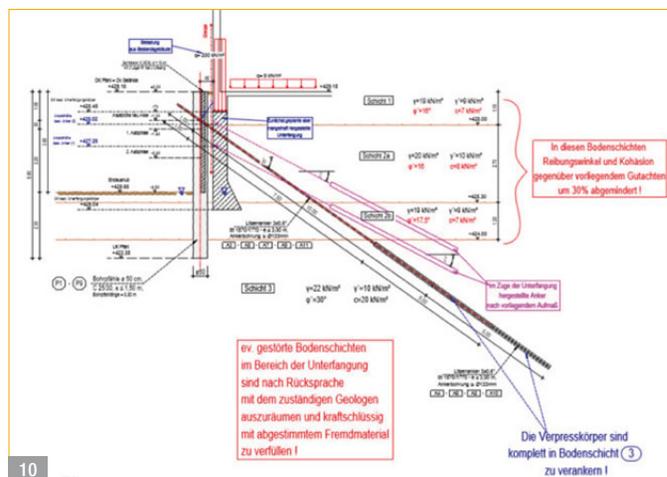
Detailschnitt der geänderten Baugrubensicherung (mit Darstellung der ursprünglichen rückverankerten Unterfangung), o. M.
